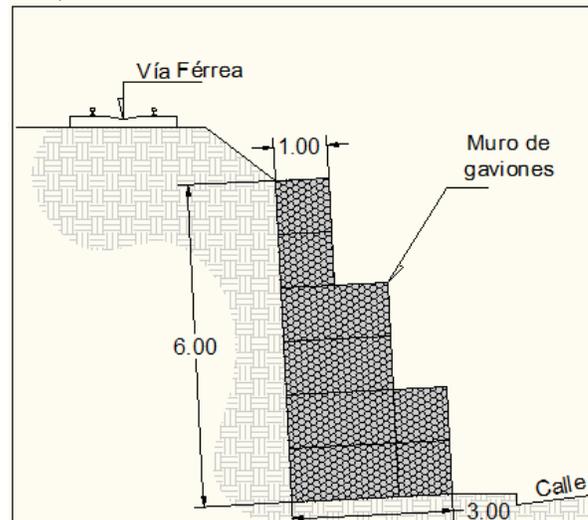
Detalle de obra complementaria #29, (Fuente: Autor)
